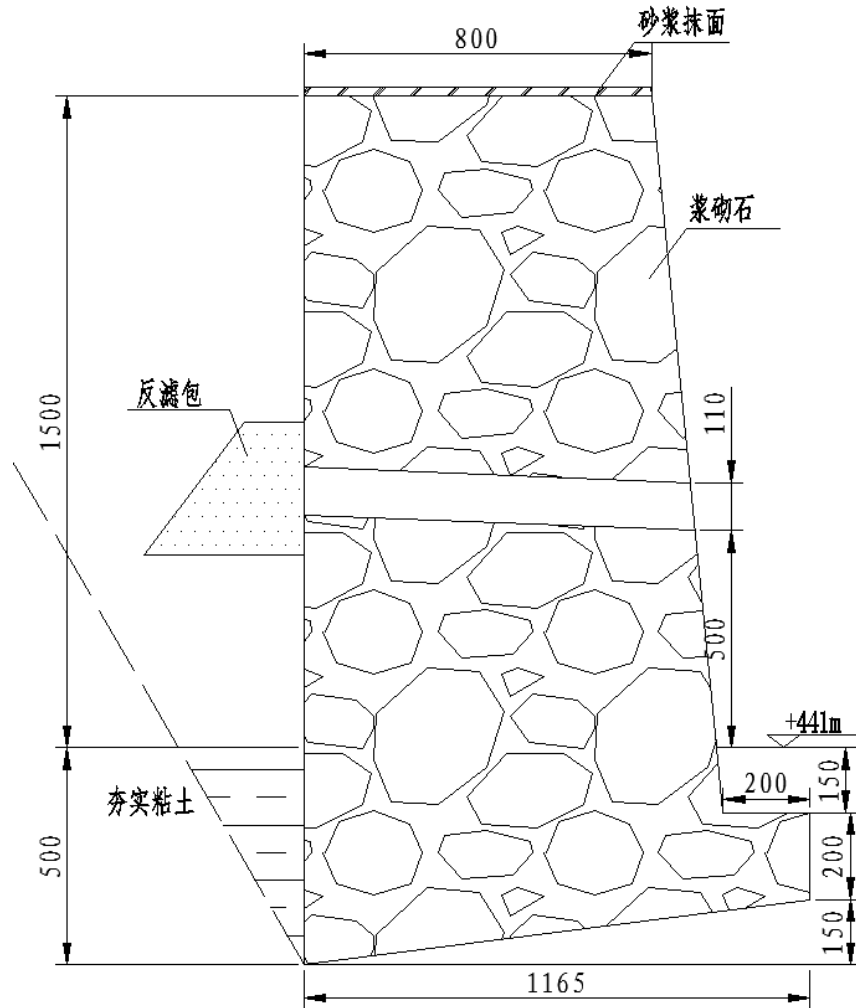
排土场底部挡土墙断面示意图 (单位: mm)
